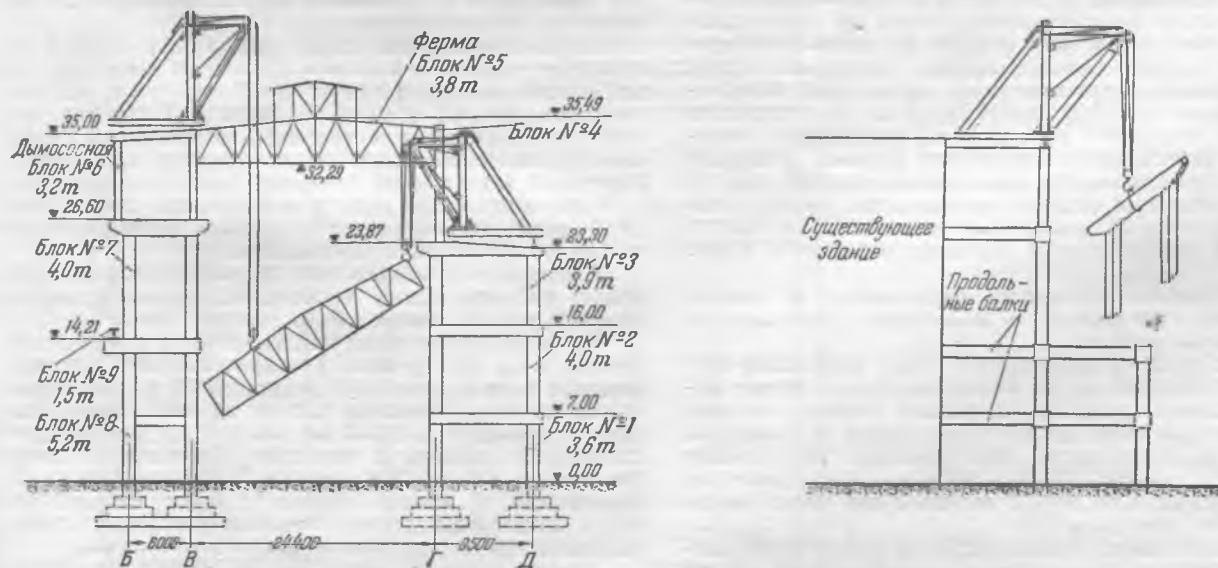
Схема монтажа каркаса здания двумя деррик-кранами.
